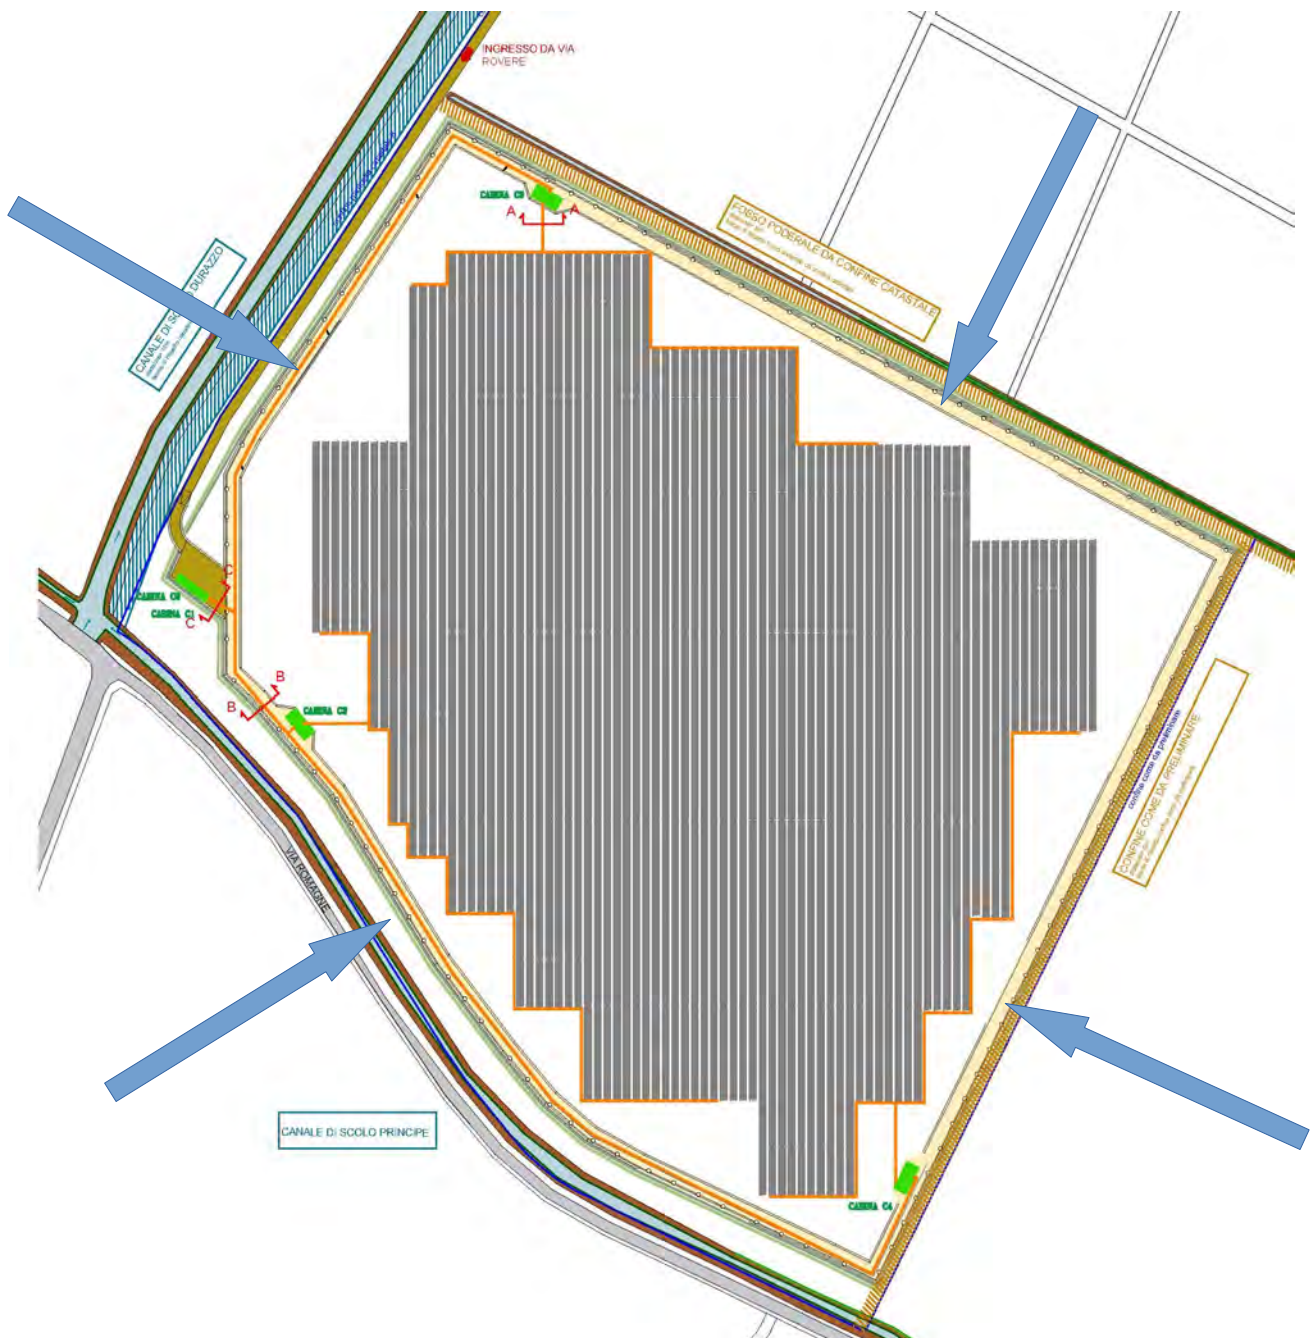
Area di impianto - individuazione area di riutilizzo delle terre e rocce da scavo
